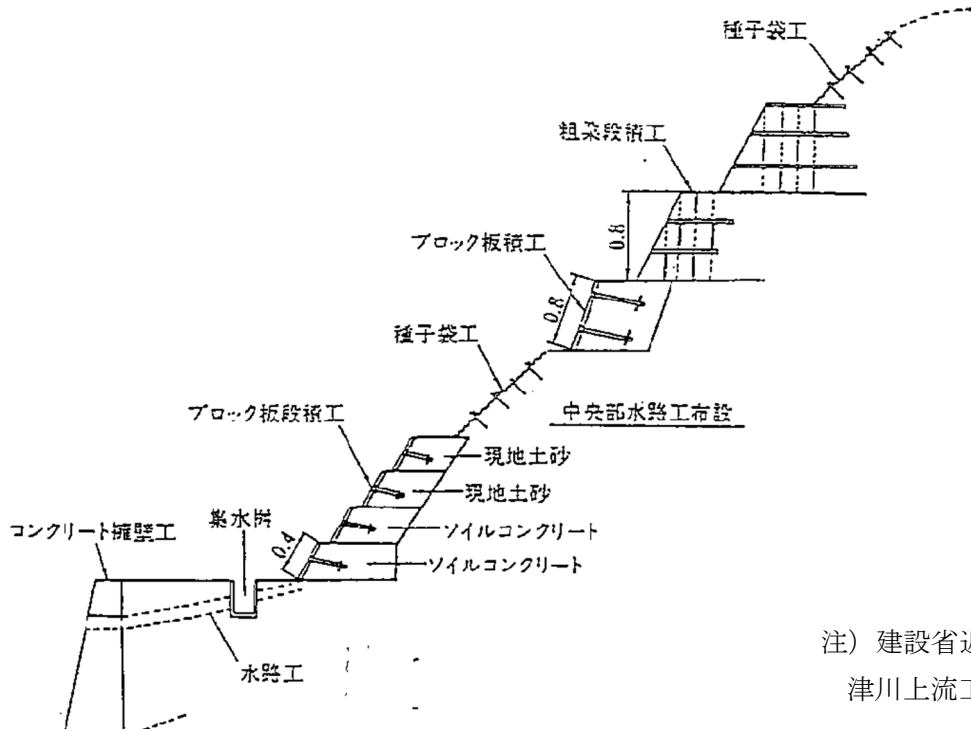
とくしゃ地（施工例）断面図（単位：m）
